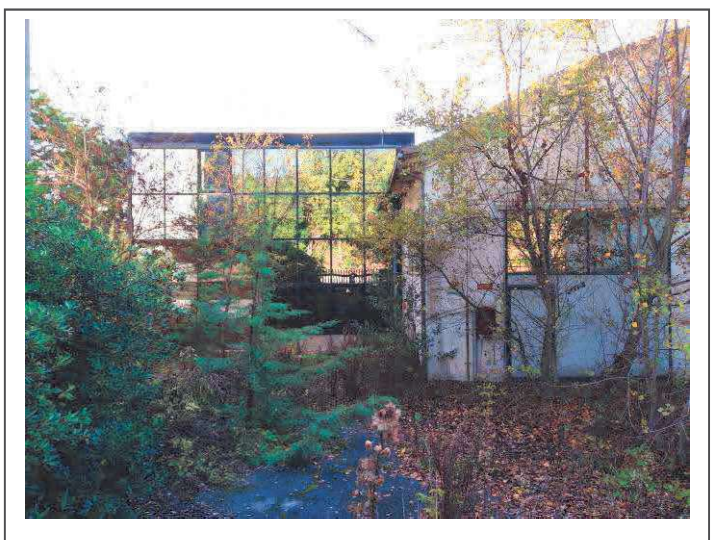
Fronte est, uffici e porzione fabbricato
